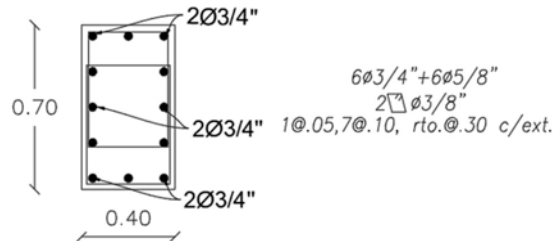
Armado de acero de la columna C-1 del 7º al 8º piso
